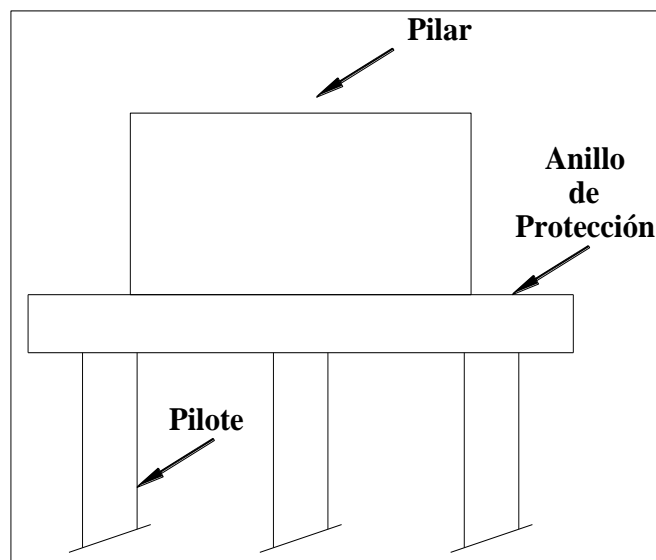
Cimentación Tipo Pilar sobre Pilotes.
